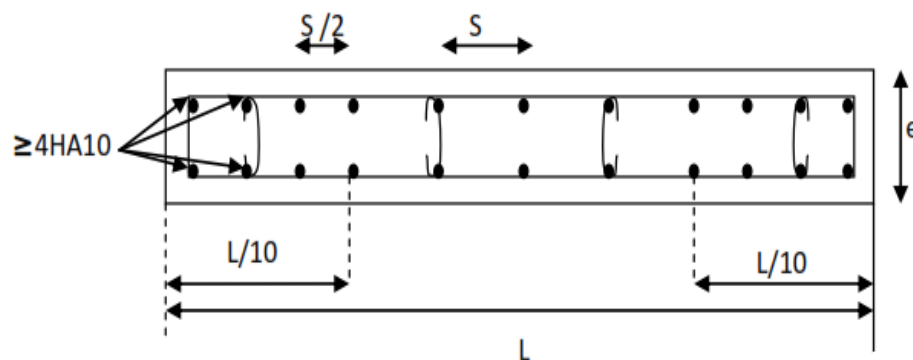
Disposition des armatures verticales dans les voiles.2. Les longueurs de recouvrement :
